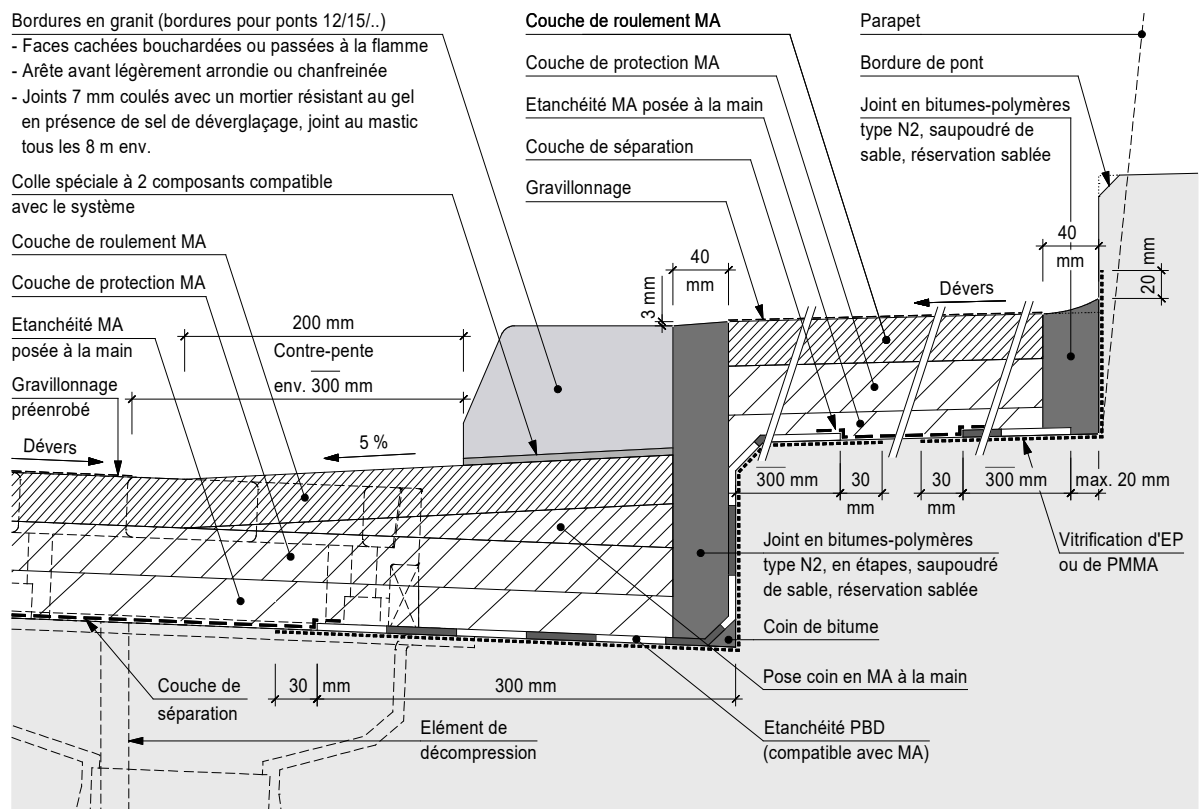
Système d'étanchéité MA - Raccord aux trottoirs - Bordure de trottoir collée - Point bas
